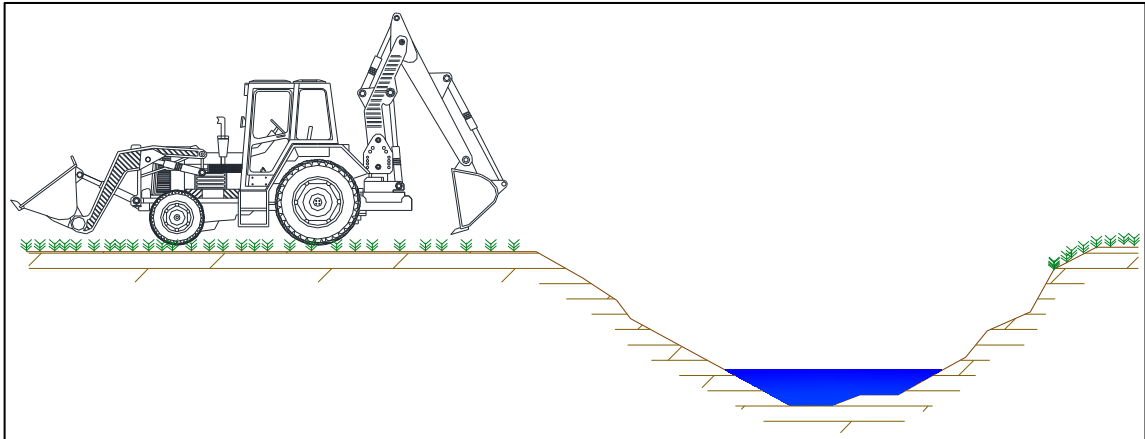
Posicionamento da retroscavadeira para construção dos barreiros.
